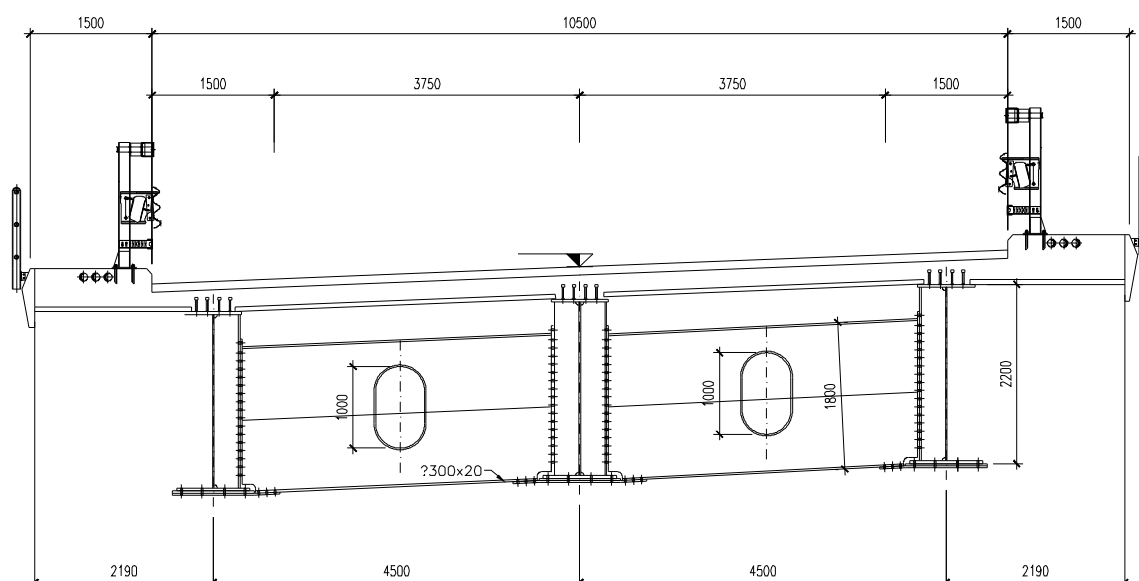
Sezione trasversale tipo impalcato 50m (Appoggio)
